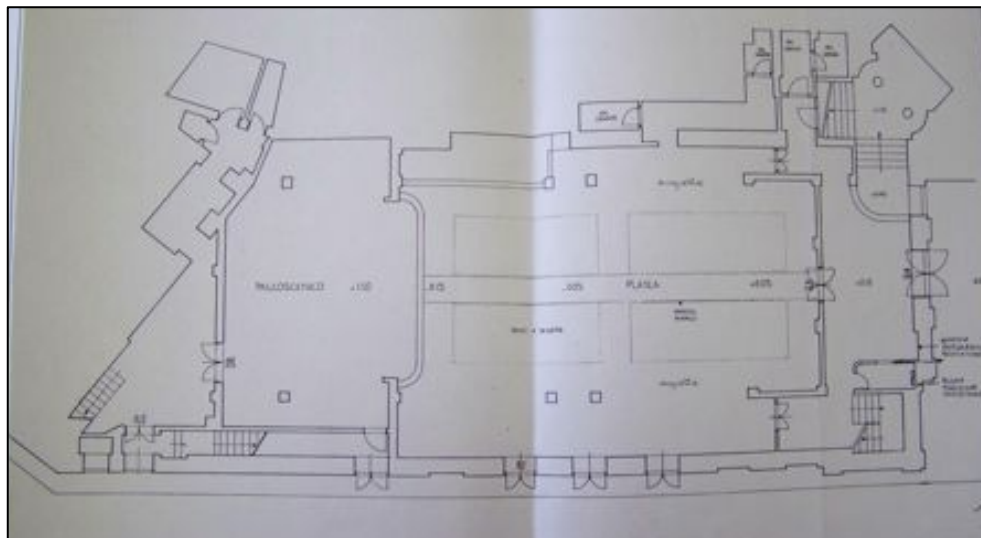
Planimetria del pian terreno, 1994 (ASBAPSAE Ce-Bn, f.1040).
